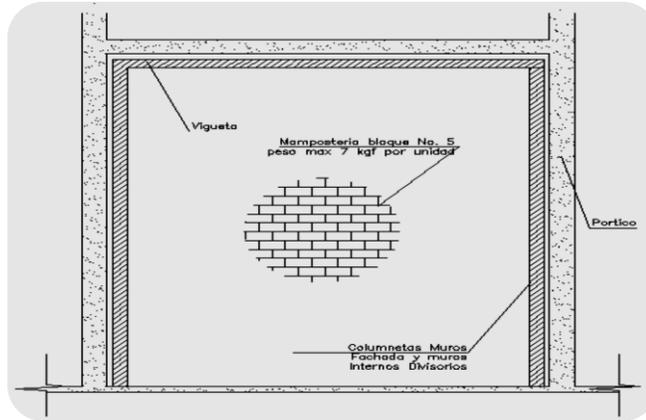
Detalle de columnetas para muros de fachada 1.10m.
